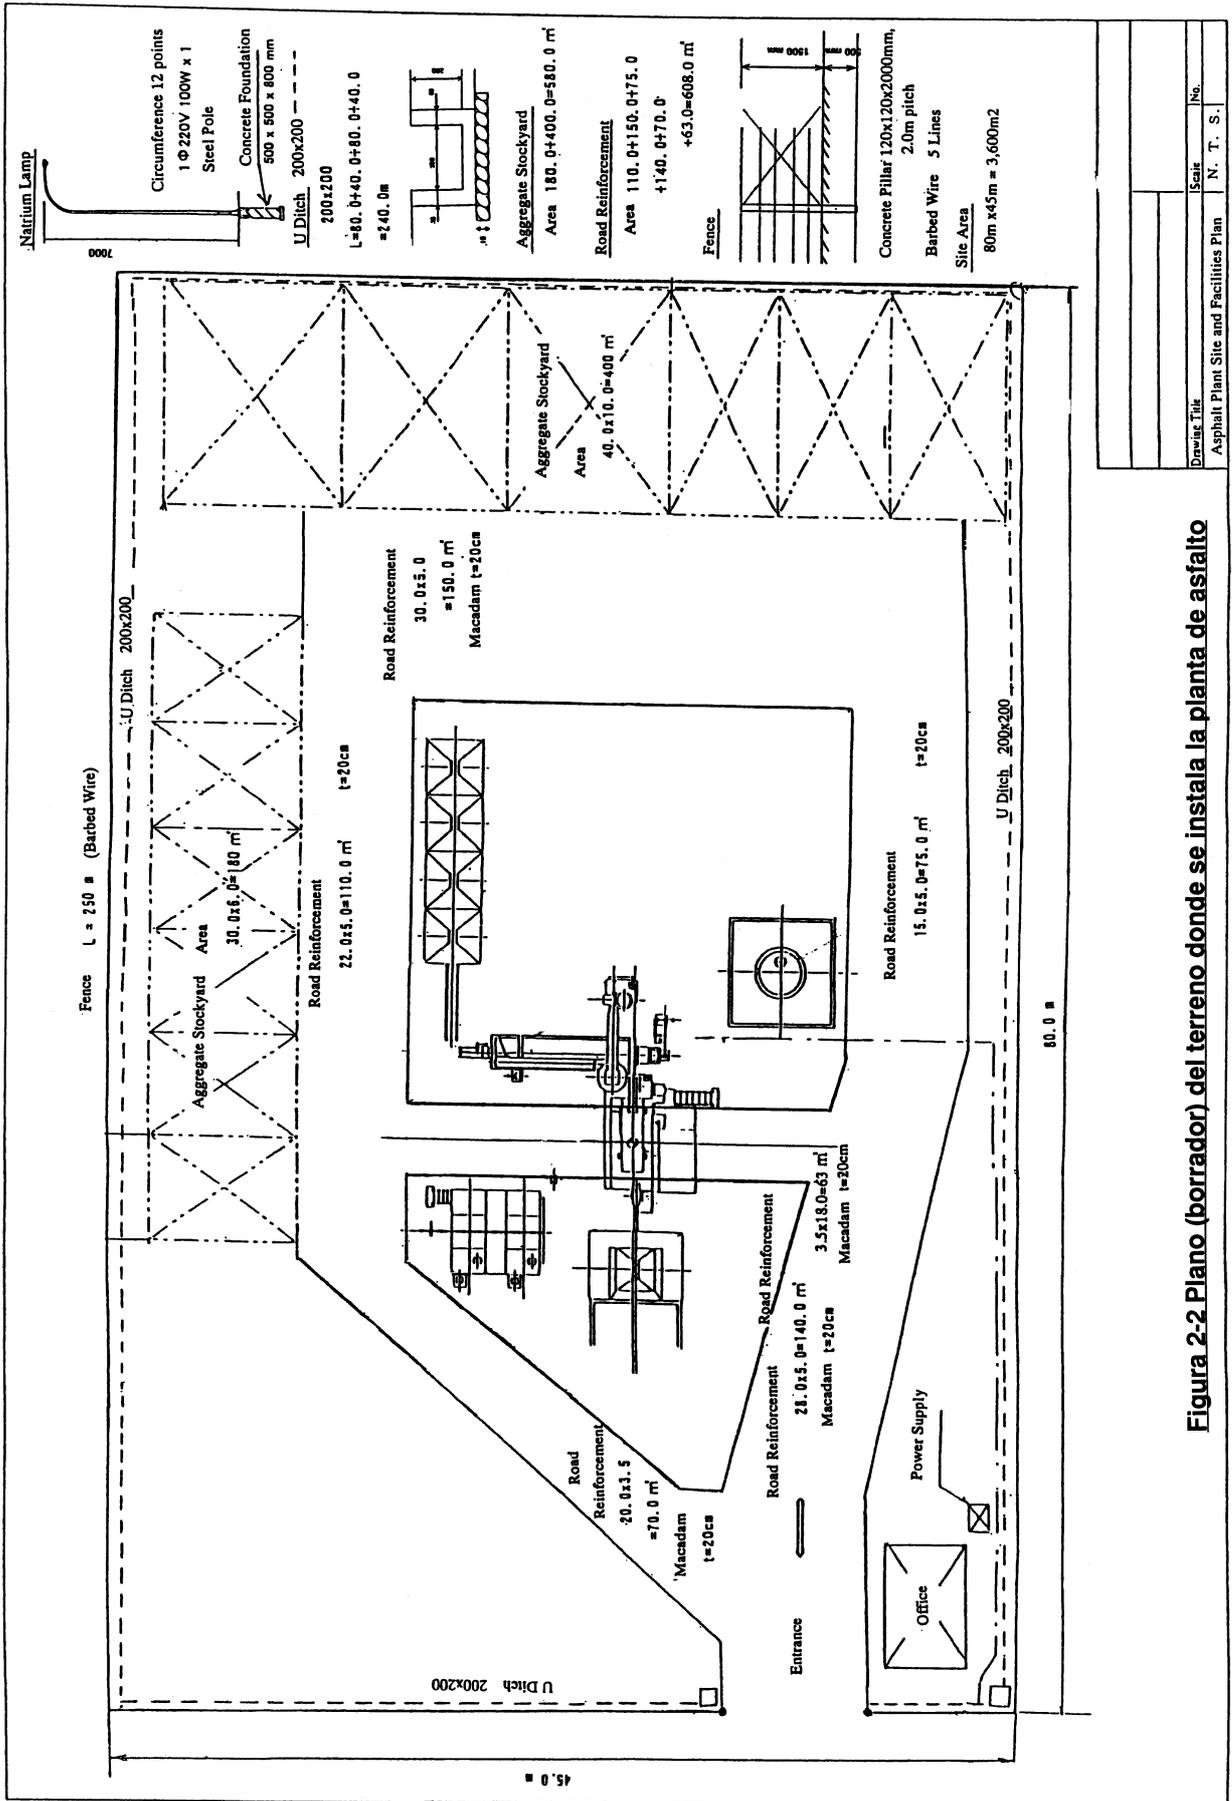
Plano (borrador) del terreno donde se instala la planta de asfalto
